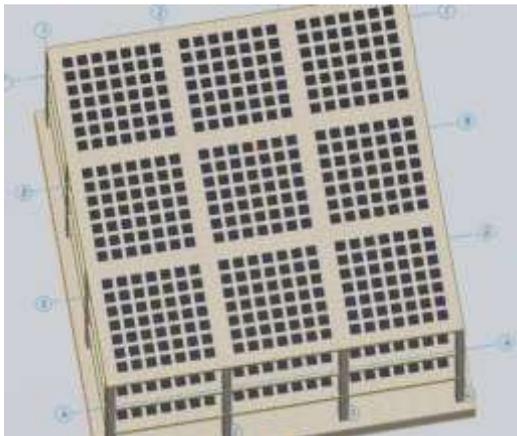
Монолитная каркасная система с плоскими эффективными перекрытиями (с газобетонными вкладышами)
